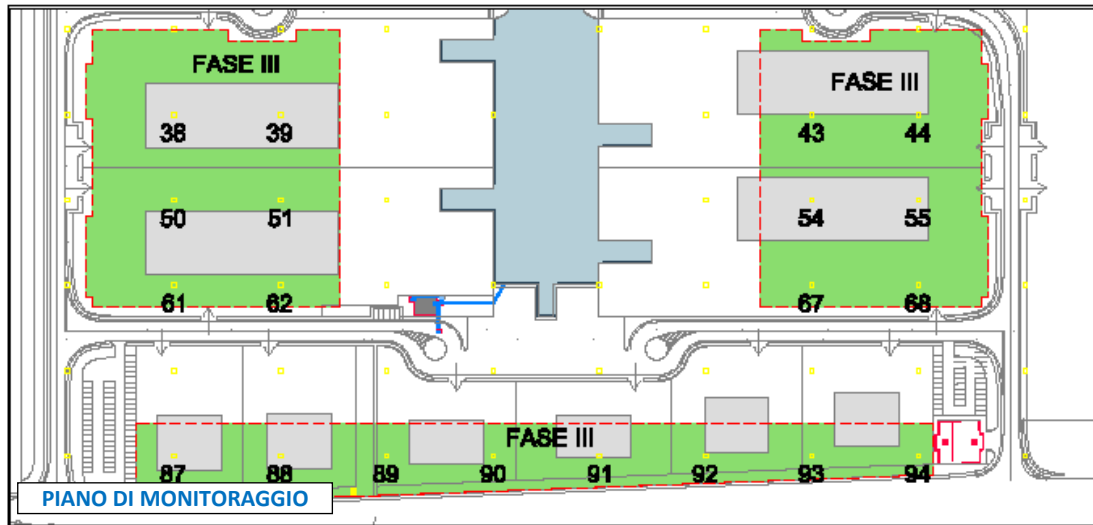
Planimetria delle stazioni di monitoraggio di III FASE.
